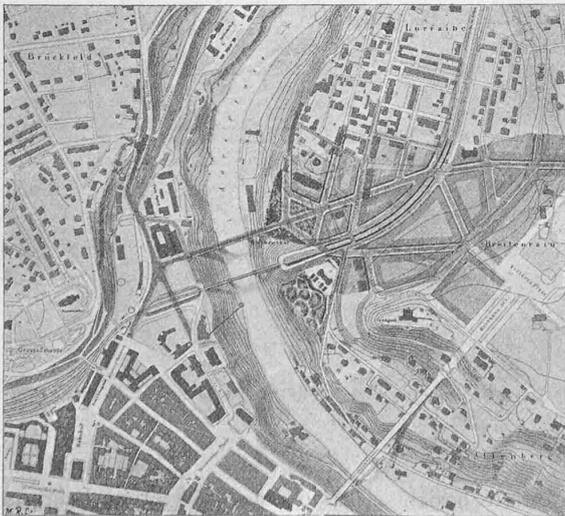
Lageplan des Entwurfs «Ehre dem Stein». — 1 : 15000.
